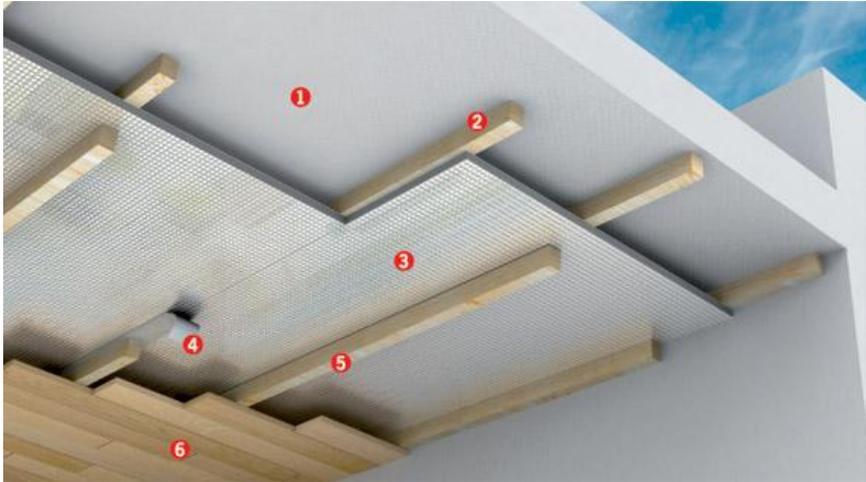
Aislamiento inferior de una cubierta por falso techo. 2014. Texsa.com
